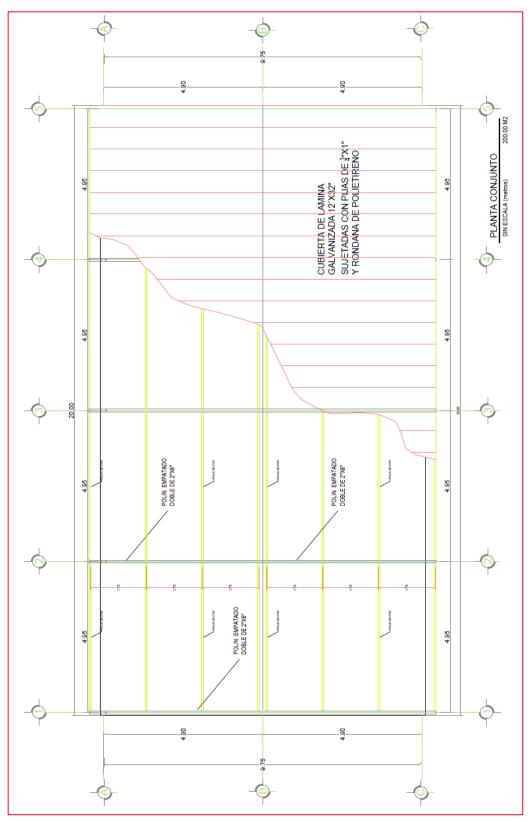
Planta de conjunto de la nave de servicio para la planta de OI.
